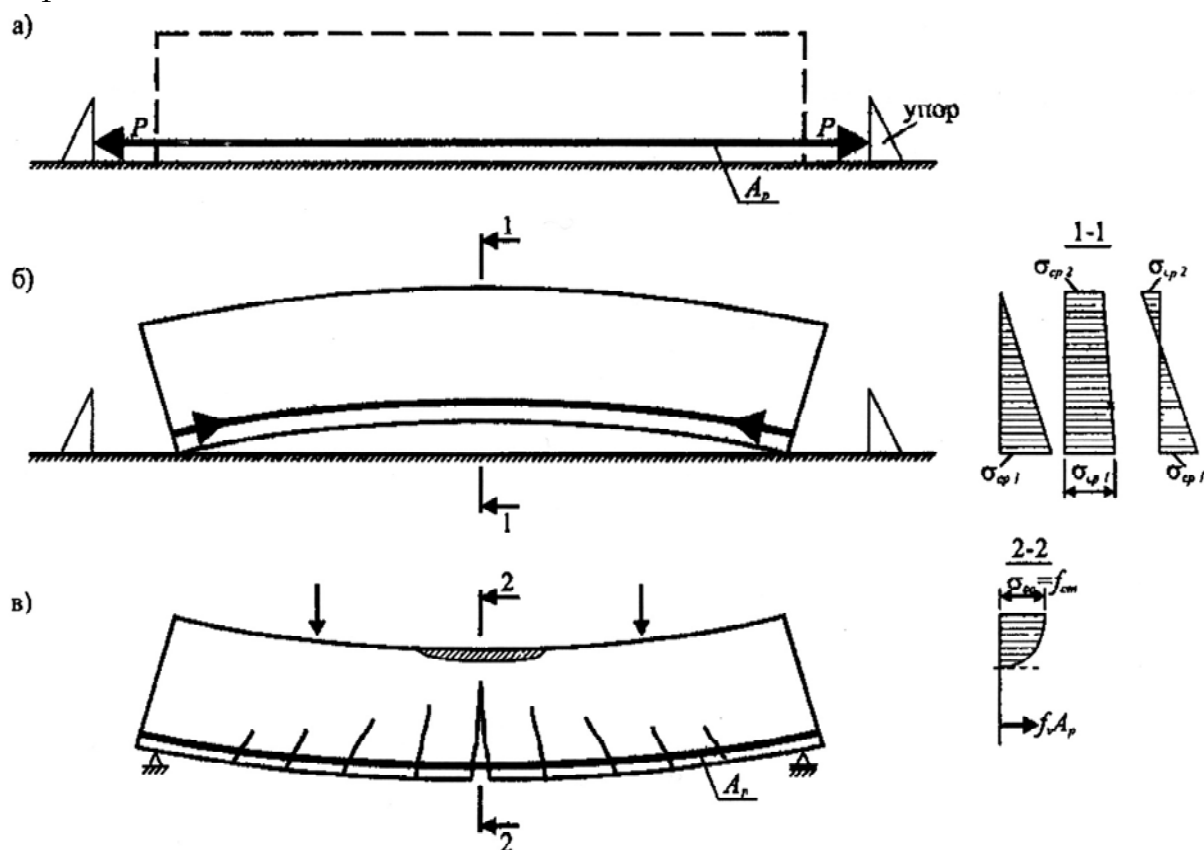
Стадии изготовления и работы предварительно напряженной балки, натяжение арматуры на упоры (а), передача усилия и возможные эпюры напряжений в бетоне (б), стадия разрушения (в)
